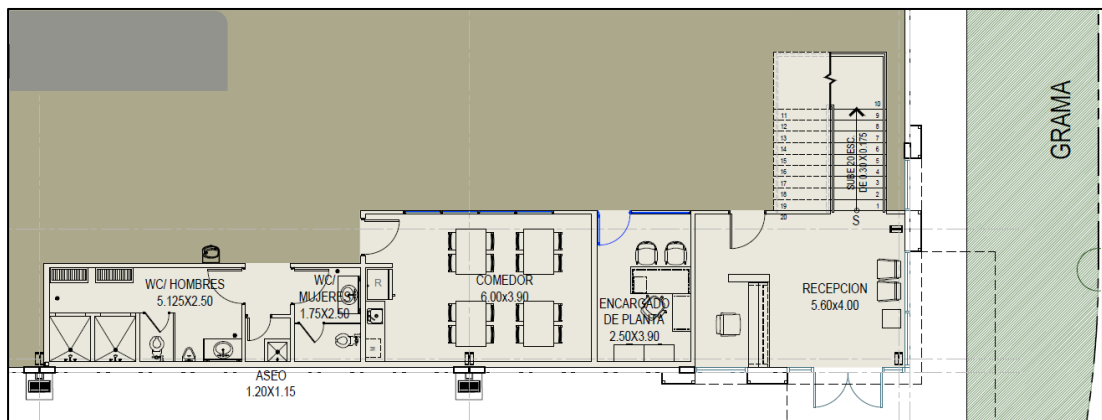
Distribución planta baja de la oficina administrativa (planta arquitectónica)
